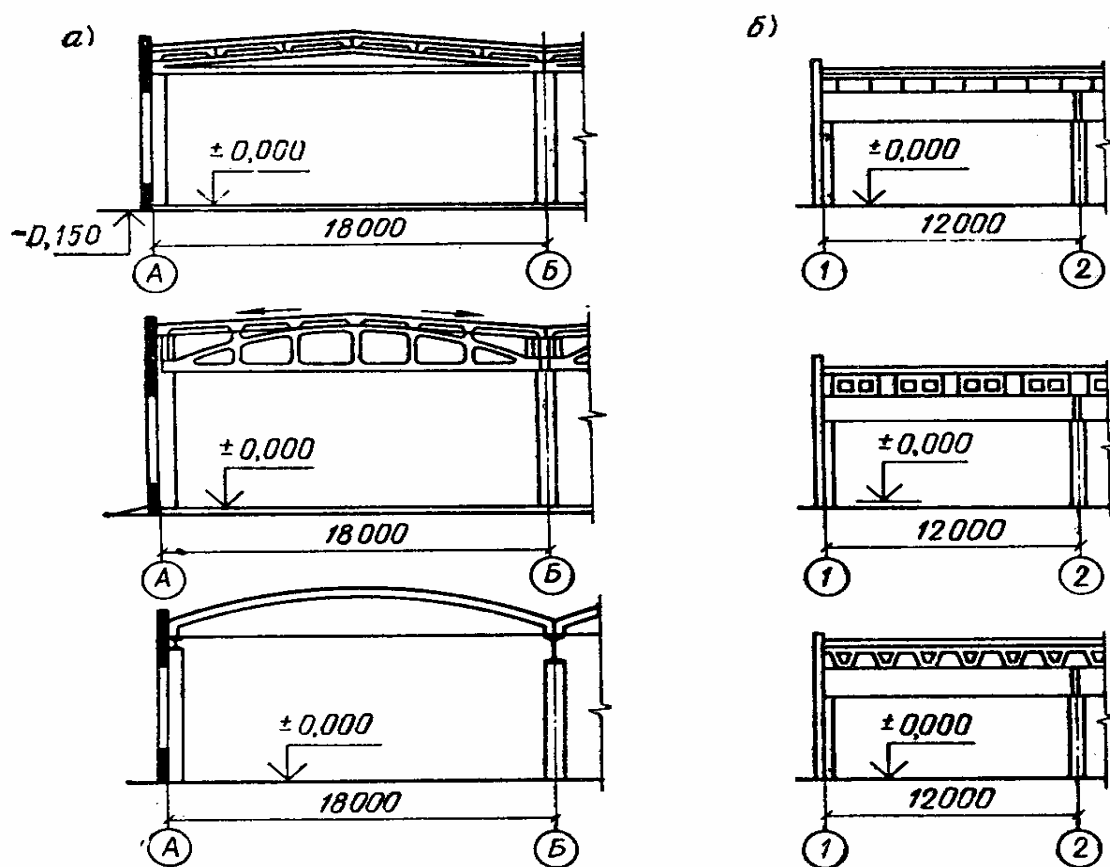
Сборные железобетонные каркасы одноэтажных производственных зданий со скатными (а) и плоскими (б) покрытиями при пролетах 18 и 12 м
